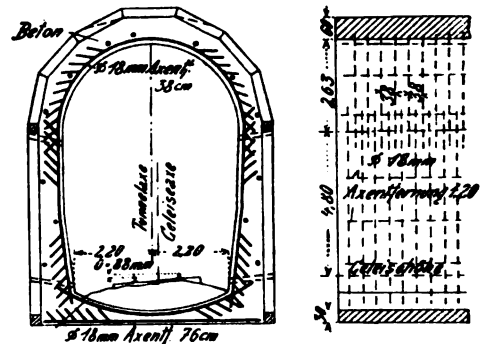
Querschnittsarmierung des Kicking Horse River-Tunnels.
